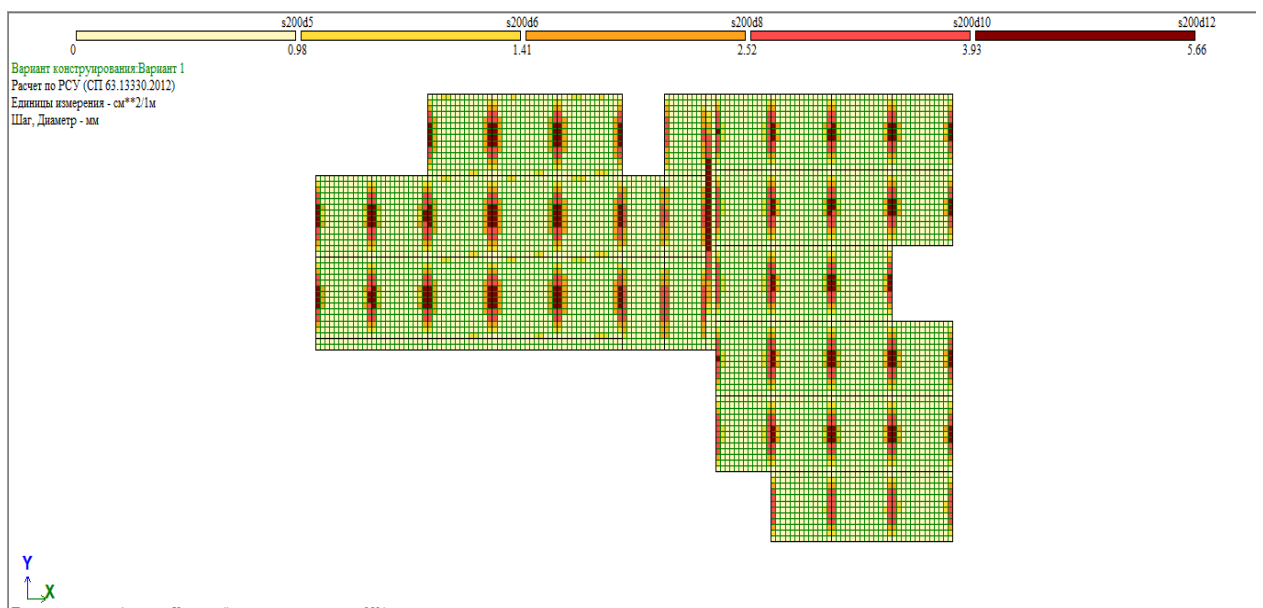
Площадь арматуры по верхней грани плиты перекрытия по оси X
